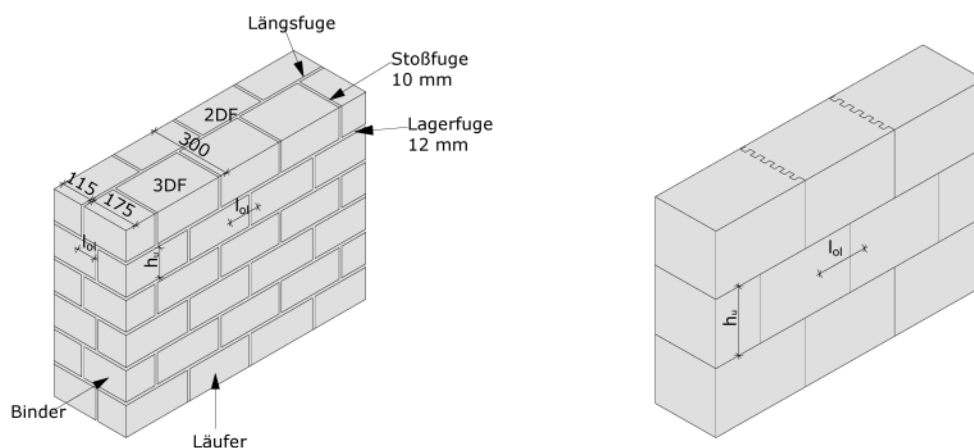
Mauerwerk mit Verbandsmauerwerk (links) und mit Einsteinauwerk (rechts)
